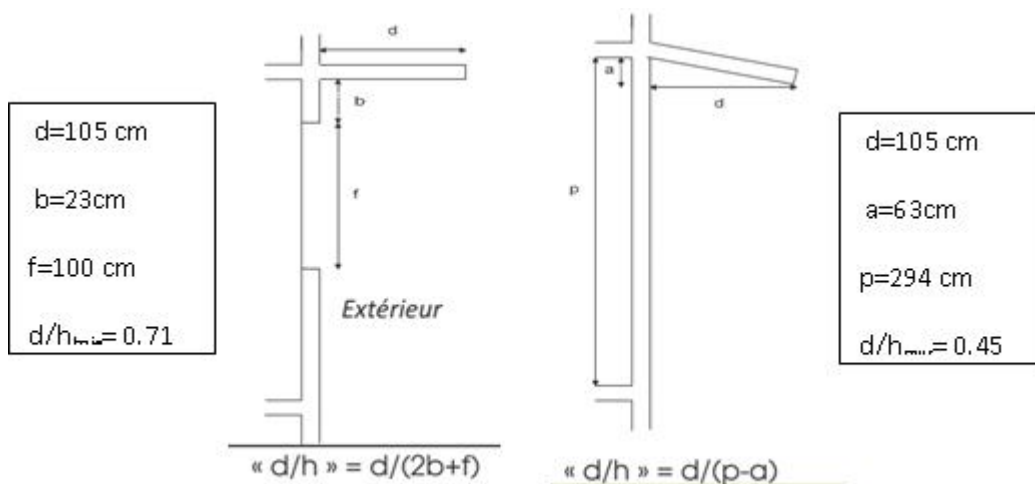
dimensions de la protection solaire des parois baies (gauche) et des murs (droite)
